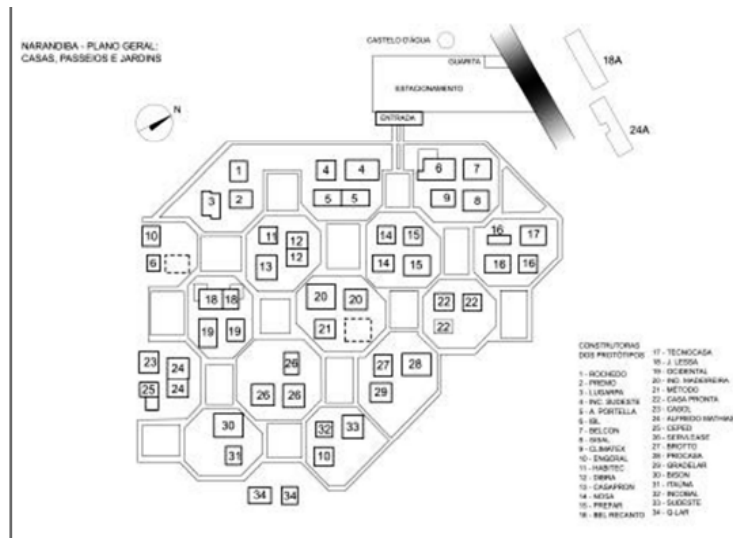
Planta esquemática do campus experimental de Naranjiba.
